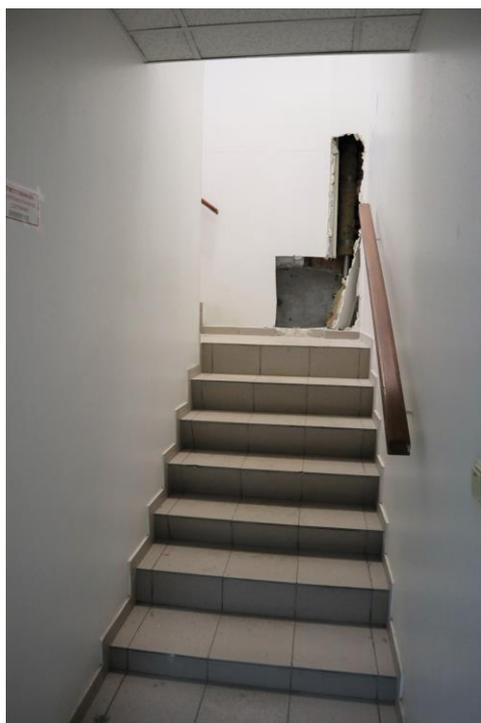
4 этаж, помещение 10Н (33), лестница двухмаршевая, в северо-западной части здания, на плане ПИБ от 24.12.2018 не обозначена.
